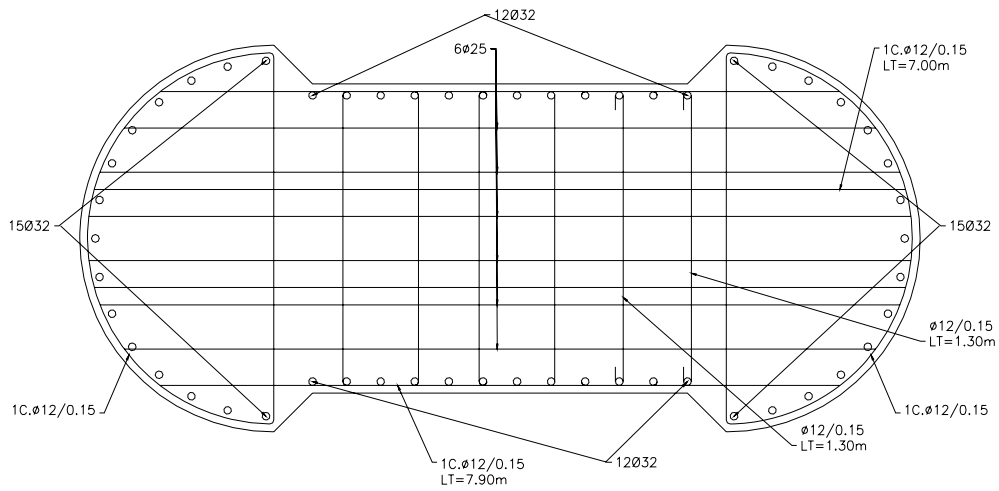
Detalle de armado de las pilas. Sección en Cabeza de pila
